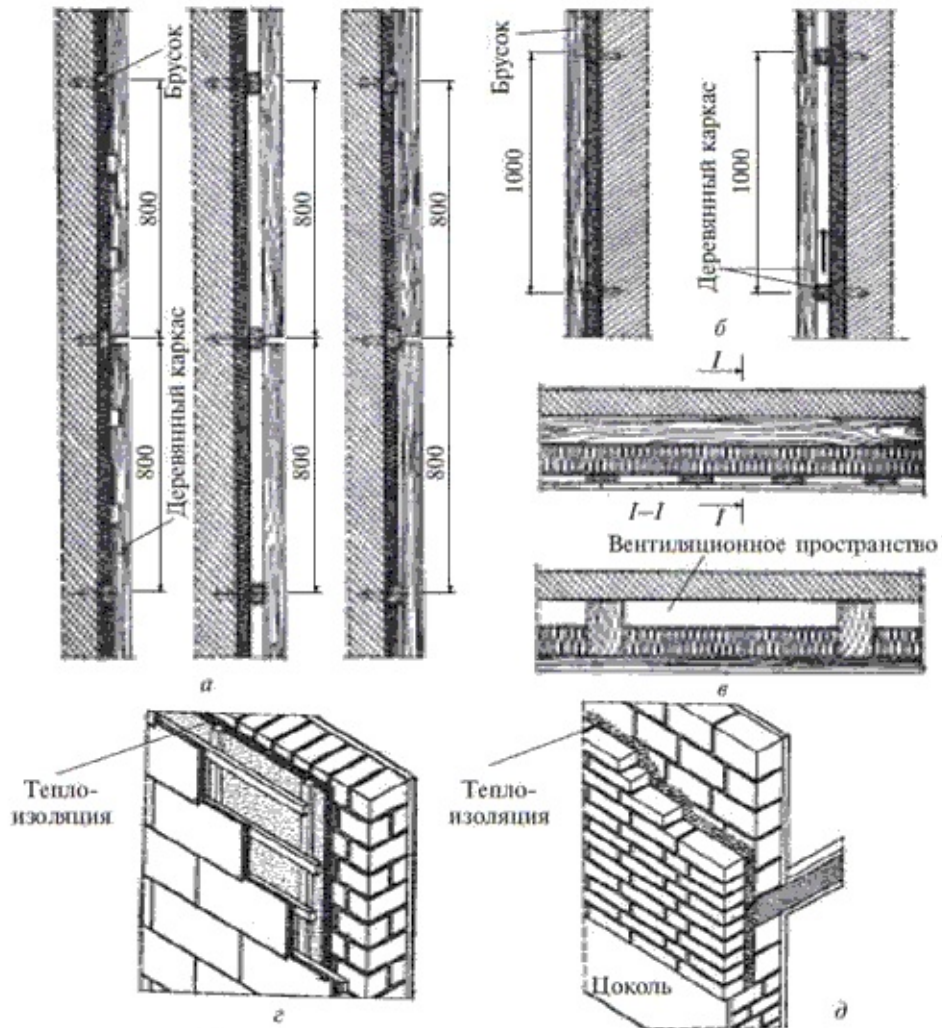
Устройство теплоизоляции на наружной стороне стены:
